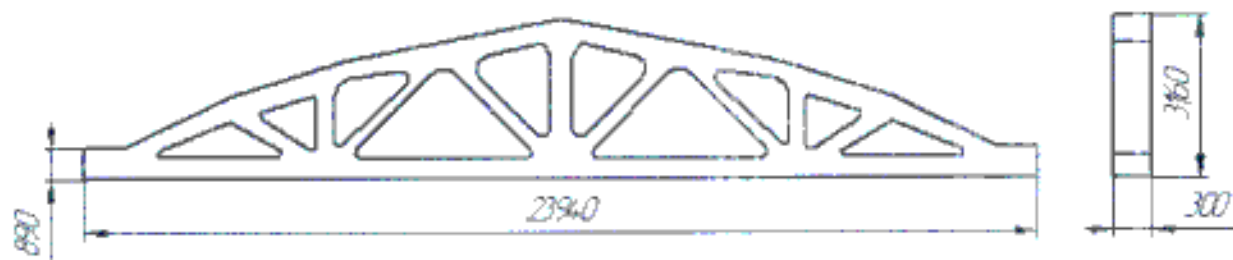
Габаритные размеры железобетонных ферм
